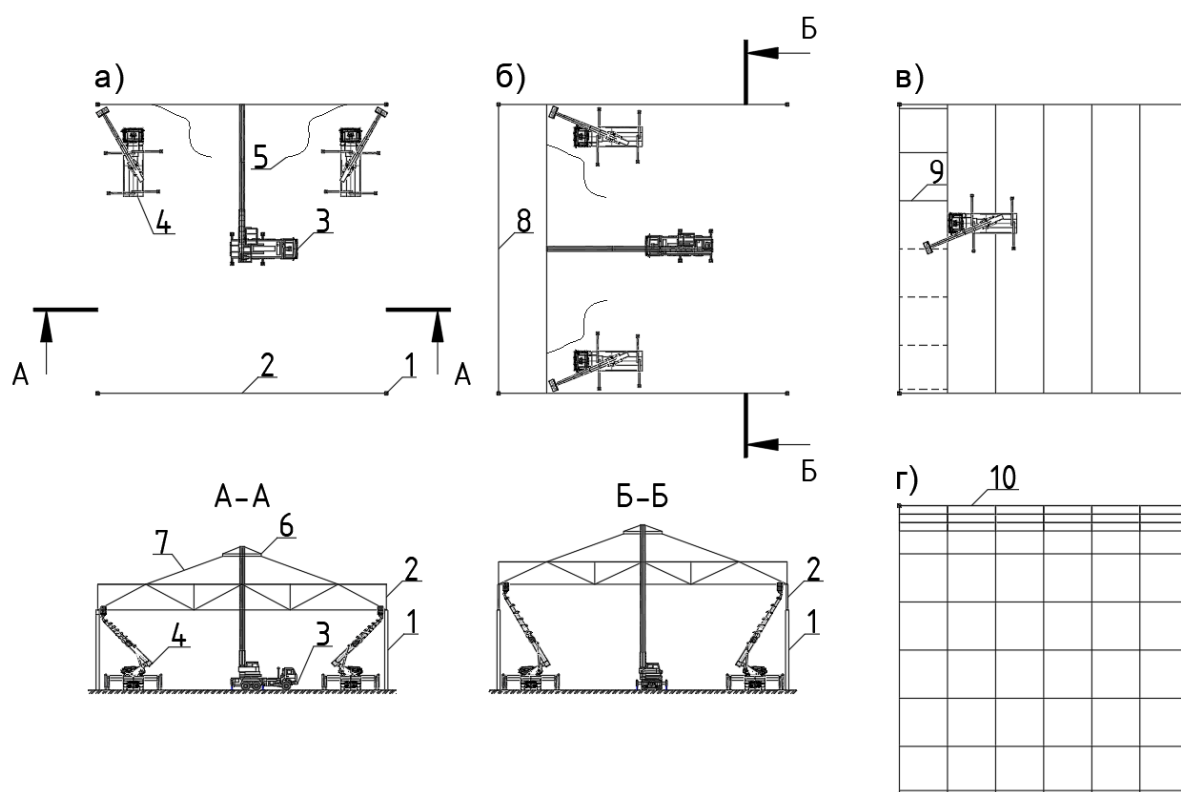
Монтаж конструкций в целом виде с предварительным укрупнением на уровне земли: а – монтаж подстропильных ферм; б – монтаж стропильных ферм; в – монтаж прогонов и связей; г – монтаж стального профилированного настила; 1 – колонна; 2 – подстропильная ферма; 3 – автомобильный кран; 4 – автогидроподъемник; 5 – оттяжка; 6 – траверса; 7 – строп; 8 – стропильная ферма; 9 – прогон; 10 – профилированный лист
